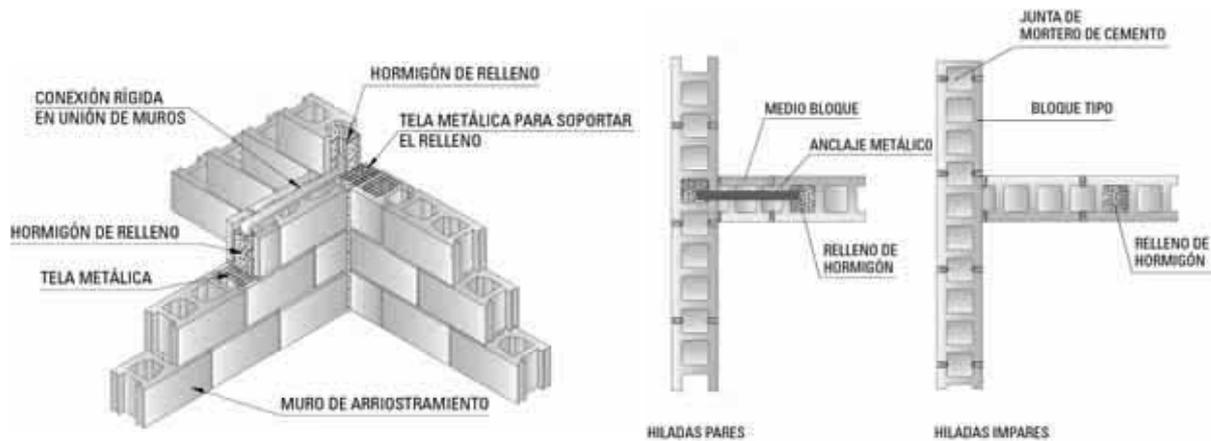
Solución de encuentro sin trabazón entre piezas. Introducción de anclaje en Z y macizado de alveolos.
